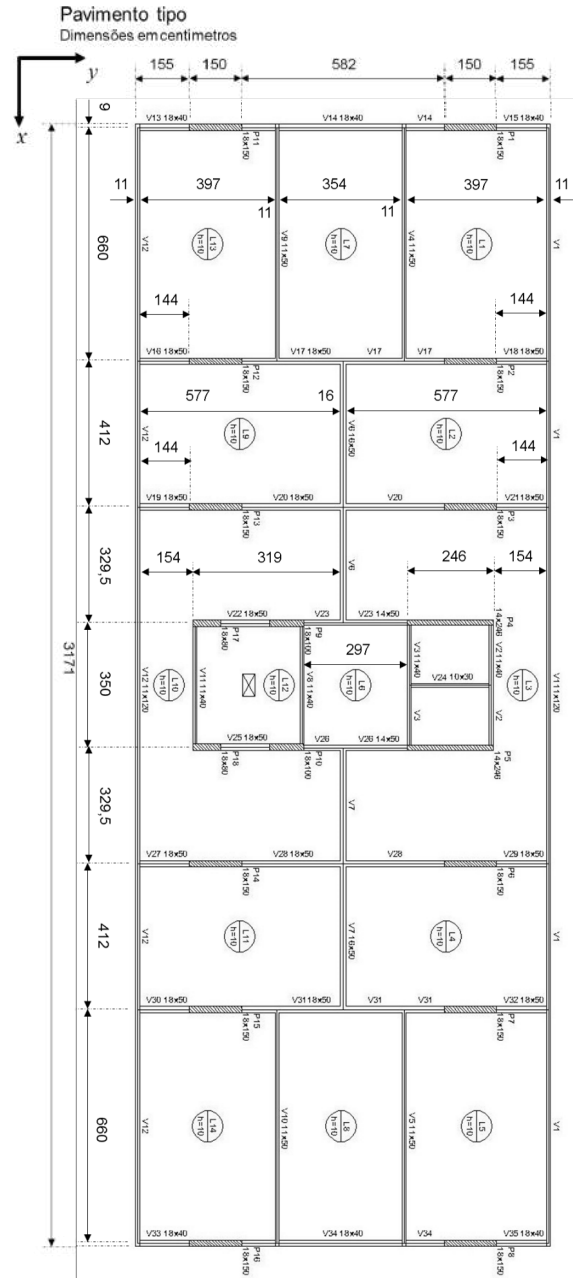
Planta de forma da estrutura. Fonte: adaptado de Fusco (1996).
